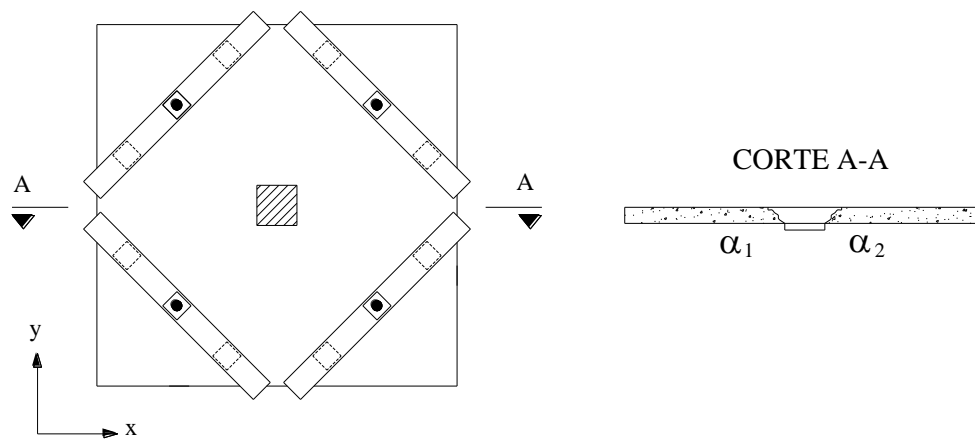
Inclinações da superfície de rotura com a horizontal [26]
